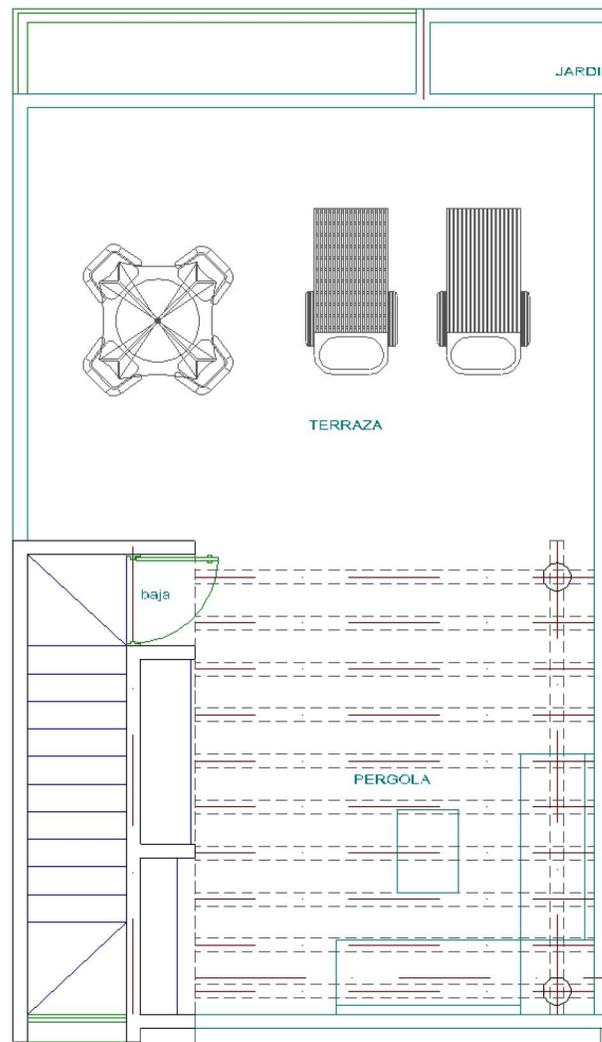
Plano arquitectónico del segundo nivel de las villas
